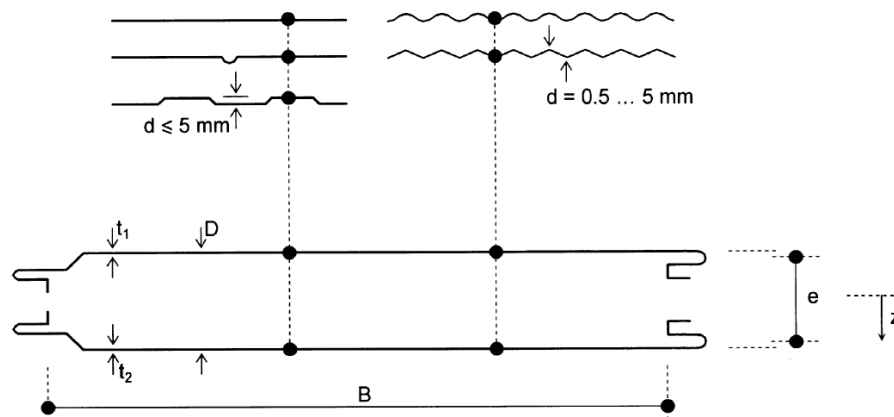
Definition Elementquerschnitt für ebene, leicht profilierete oder mikroprofilierete Deckschichten [5]
